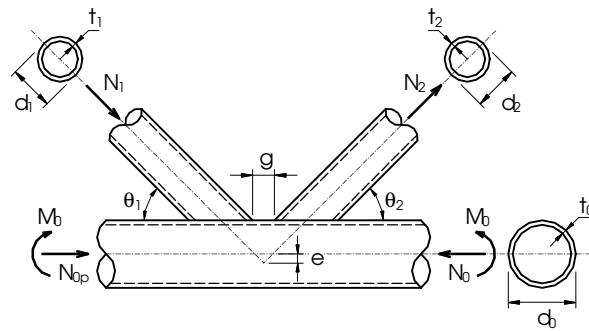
Ligação “K” com afastamento e banzo com seção tubular.
